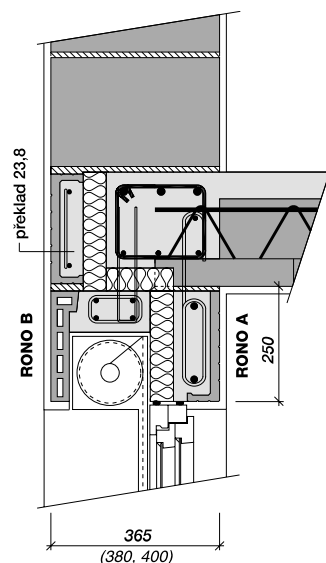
Příčný řez nadokenním překladem ve stěnách tl. 300, 365, 380, 400, 440 a 490 mm
